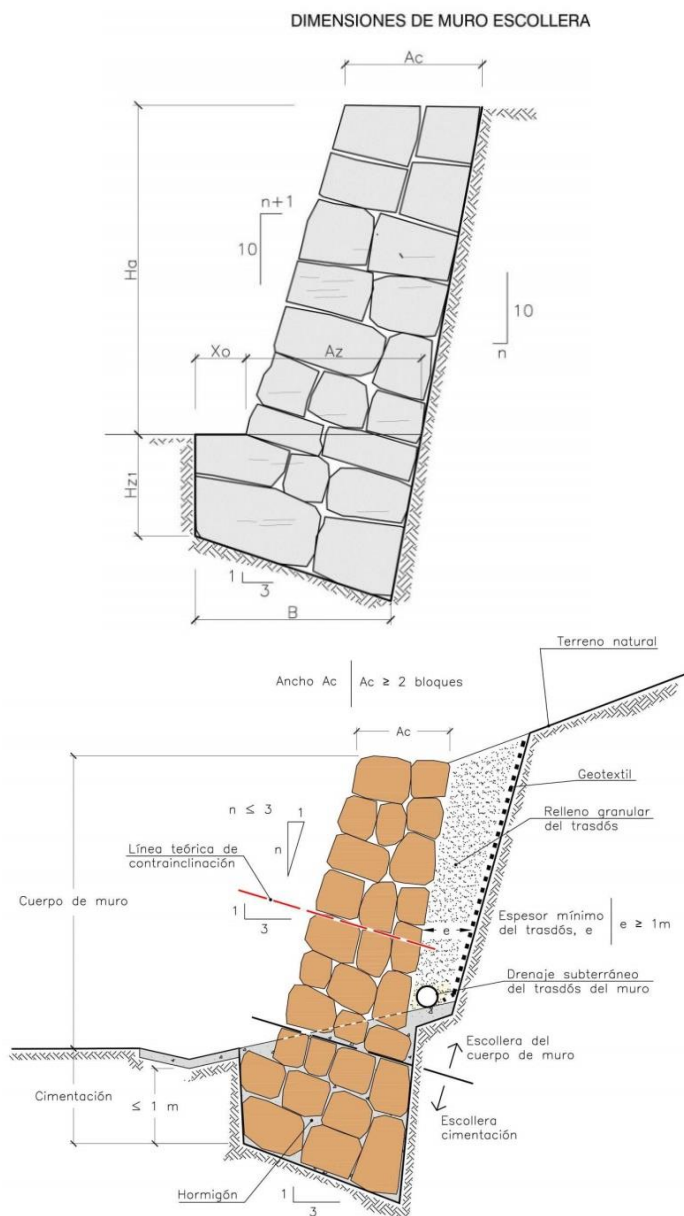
Esquema constructivo de un muro de escollera. Fuente: Guía para el proyecto y la ejecución de muros de escollera en obras de carretera, 2006.
